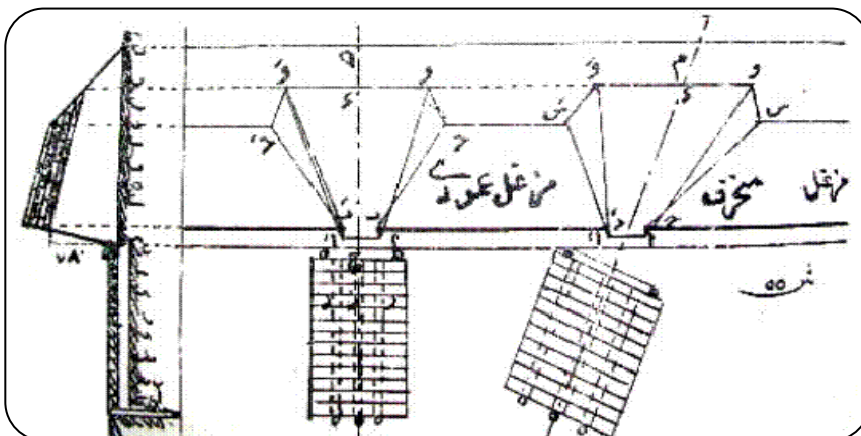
مسقط أفقي تحليلي لمزغل المدفع (رسم بمعرفة الباحث)
